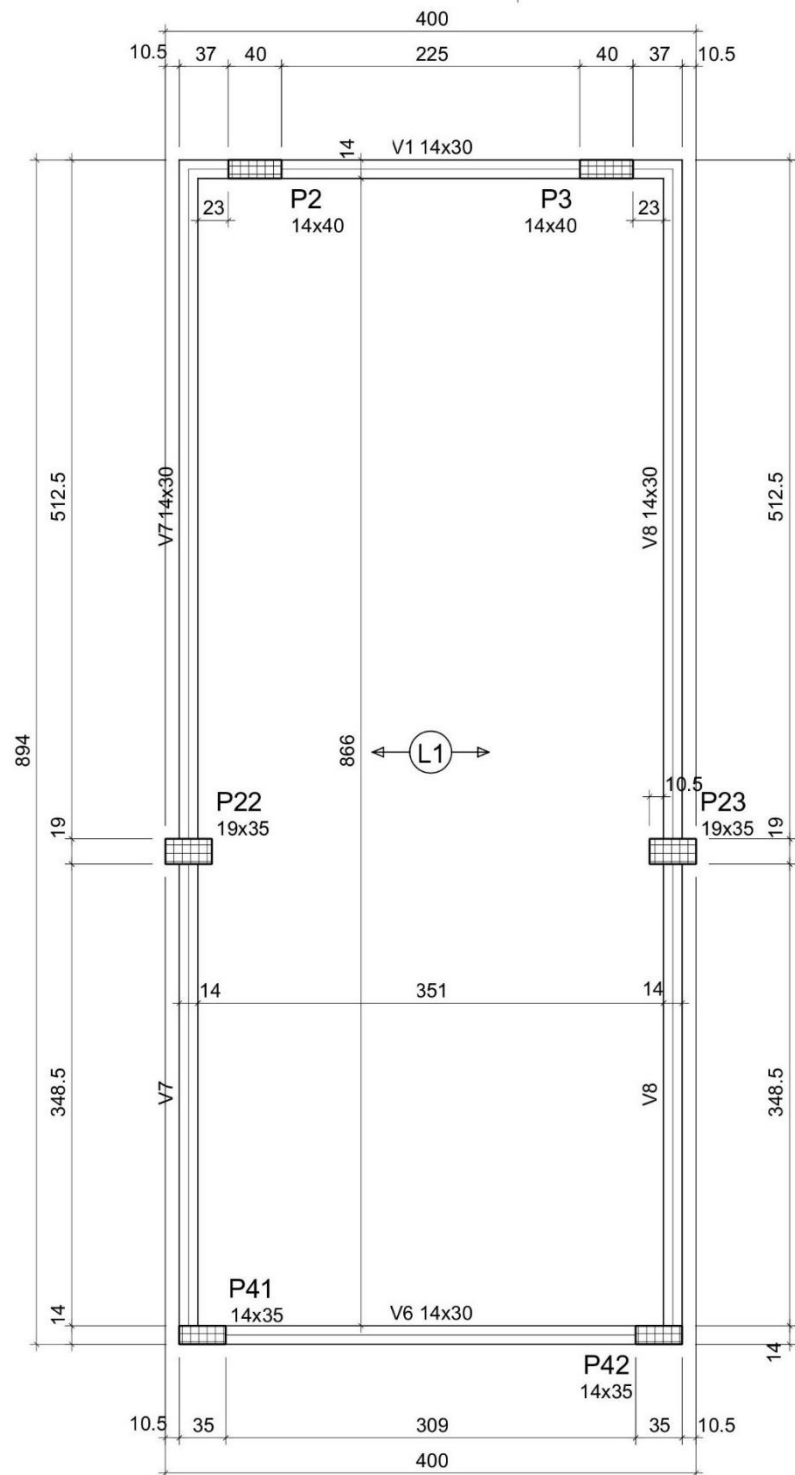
FORMAS DO PAVIMENTO COBERTURA SEM ESCALA
